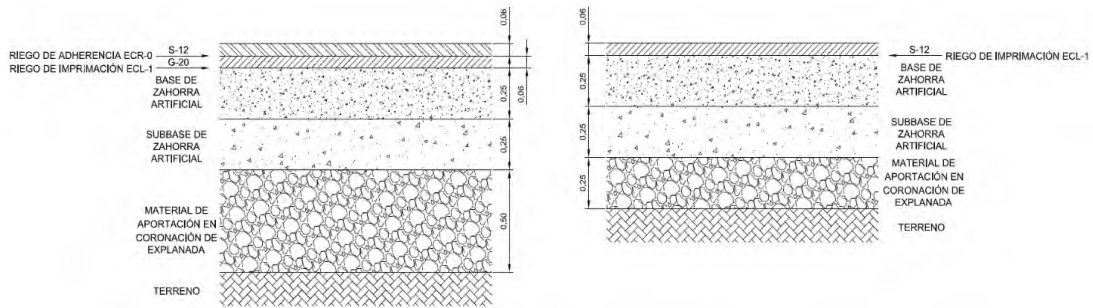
Sección tipo de firme existente en explanada de Espigón según proyecto de construcción original (izquierda, zona de viales; derecha, zona aparcamientos).
